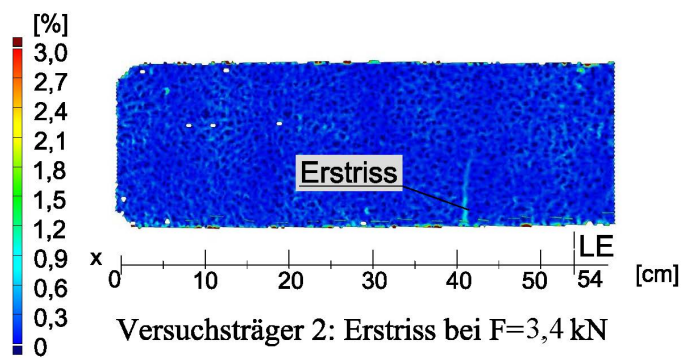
Versuchsträger 2- Lage Erstriss
